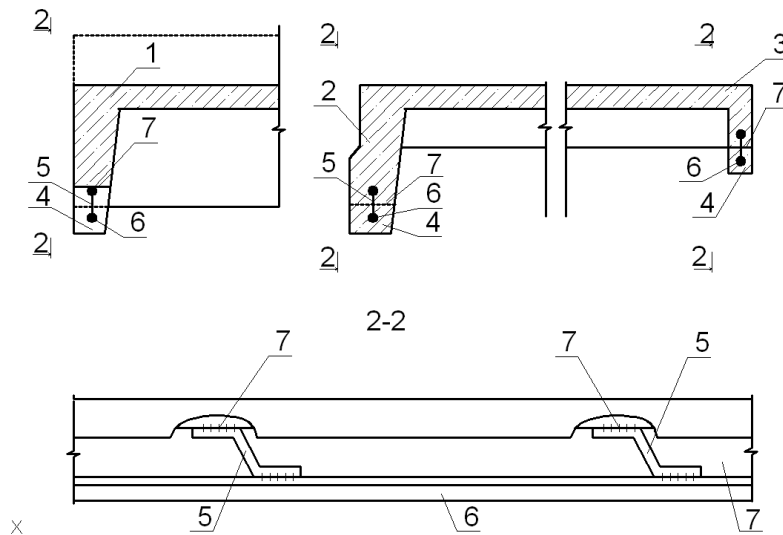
Улаштування залізобетонного нарощування в розтягнутій зоні:
